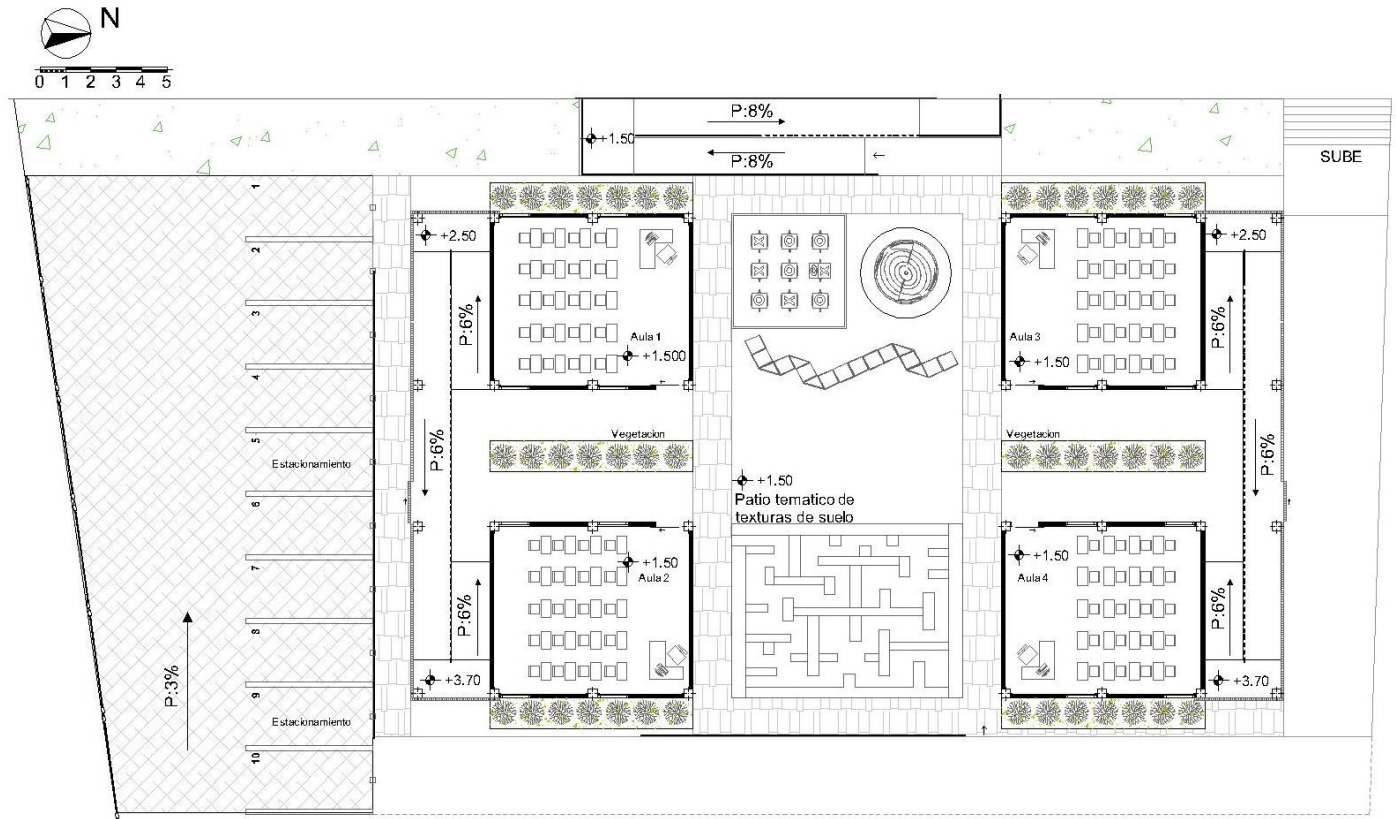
Planta arquitectónica, plataforma 0, tercera planta
